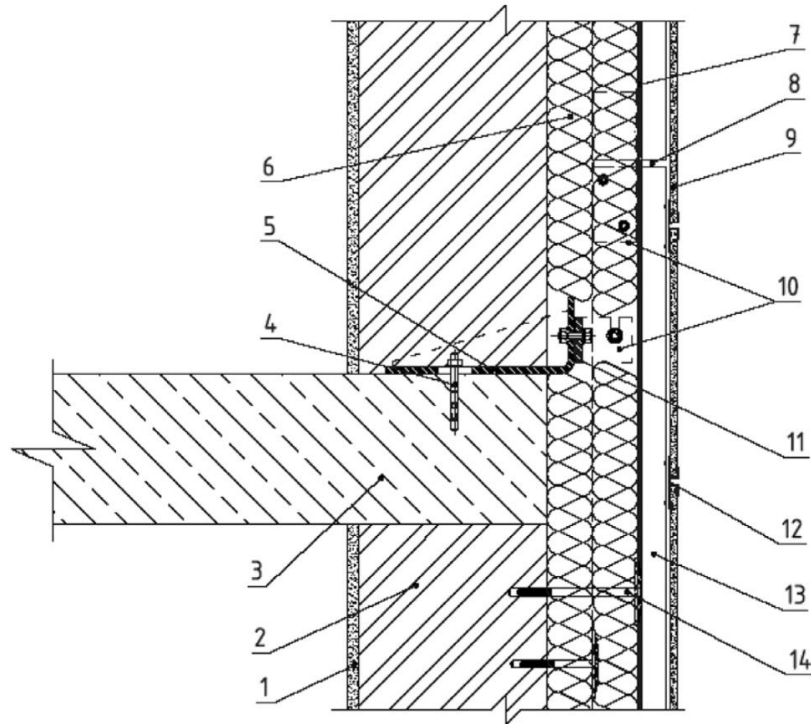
Конструктивна схема збірної фасадної системи із стояковим кріпленням зовнішнього оздоблювального захисного шару: 1 - внутрішня штукатурка; 2 - несуча частина стіни; 3 - залізобетонна плита перекриття; 4 - анкер клиновий; 5- кронштейн; 6 - шар теплової ізоляції; 7 - повітрозахисна мембранна плівка; 8 - повітряний вентиляований прошарок; 9 - індустриальні личкувальні елементи (керамічні плити); 10 - з'єднальні елементи; 11 - прокладка; 12 - кляммер; 13 - стояк; 14 - елемент механічного кріплення утеплювача.
